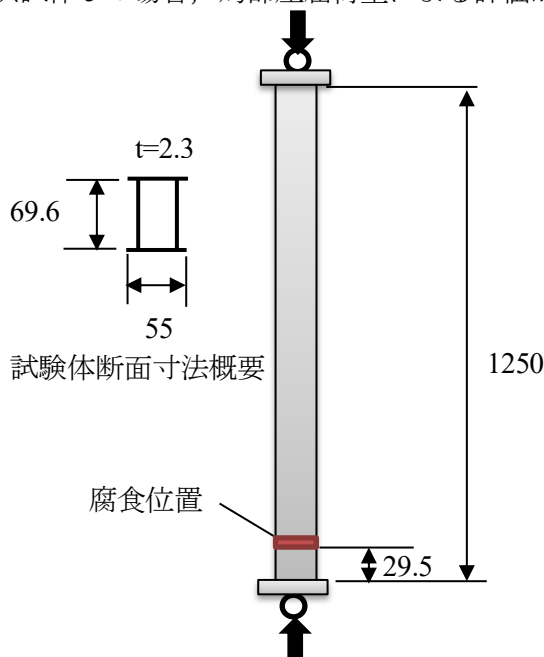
実験供試体および載荷概要 (寸法単位 : mm)
